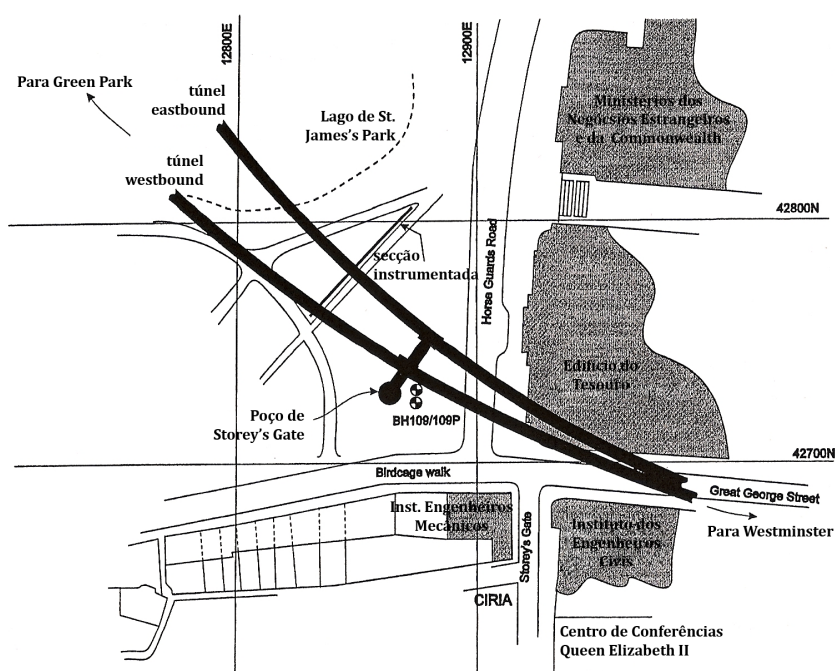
Plano da área de St. James's Park (adaptado de Nyren, 1998).
